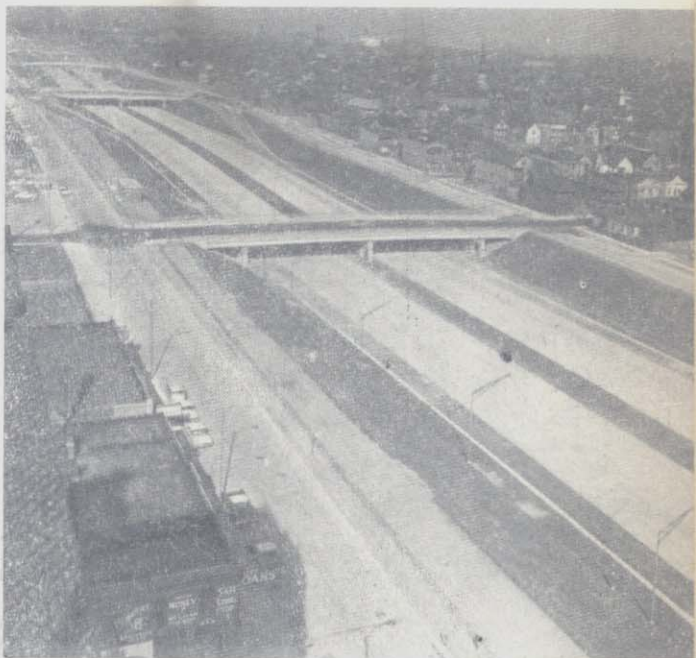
La "Eisenhower Expressway" se caracteriza por ubicar en su franja central dos vías ferroviarias del tren elevado de Chicago. Puede verse en la fotografía el punto de partida del tren elevado en esta sección de la carretera.
